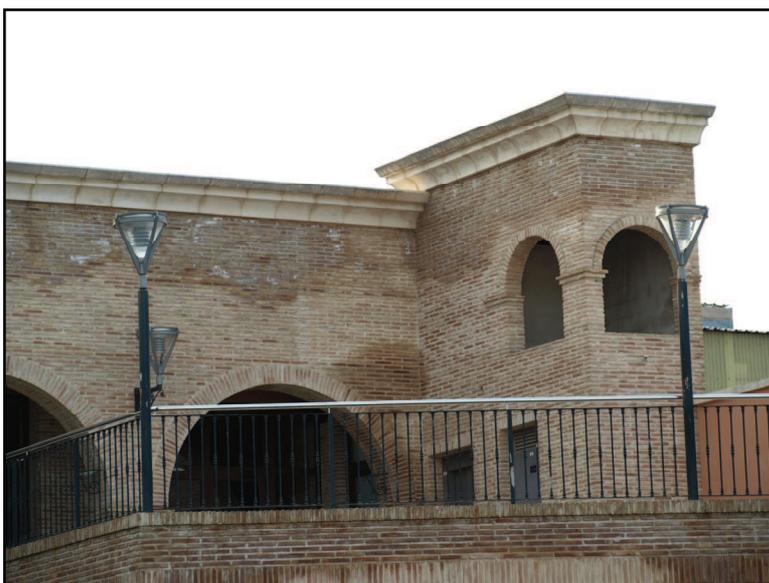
Fachada de ladrillo con manchas de humedad, y eflorescencias. Restaurante Ranga II. Carretera de Fortuna (Murcia).
